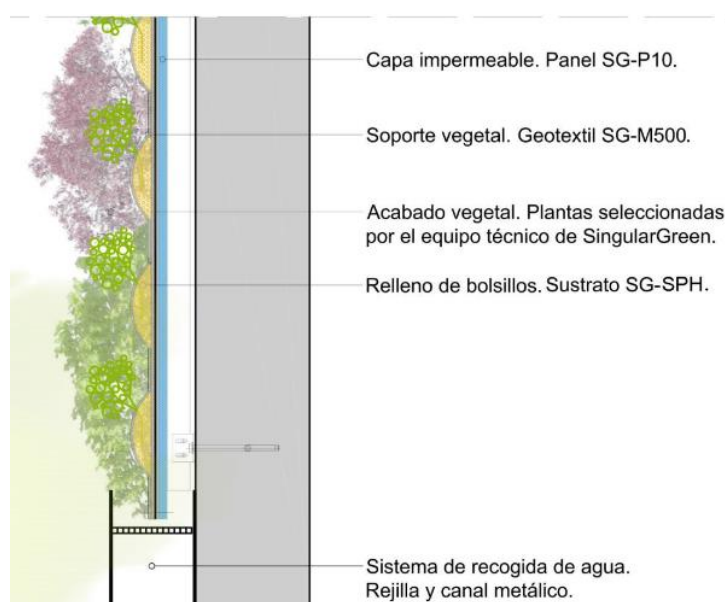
Detall constructiu del sistema F+P MIXTO.
